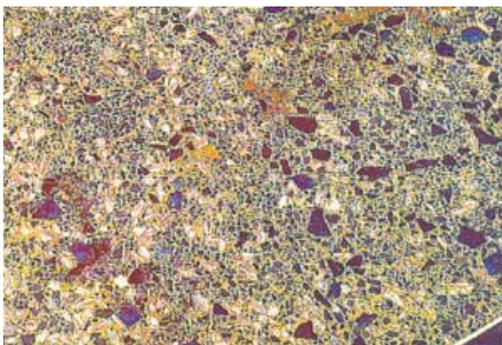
Schadensfall. Auf der Oberfläche einer Betonwerksteinstufe haben sich Risse gebildet.
